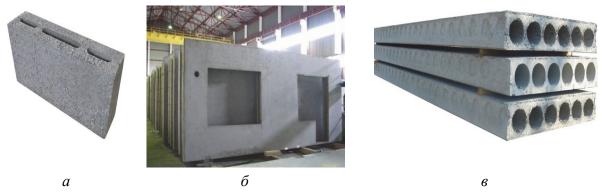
Детали строительных конструкций: a – бетонный блок;  $\delta$  – железобетонная панель;  $\epsilon$  – железобетонное перекрытие
